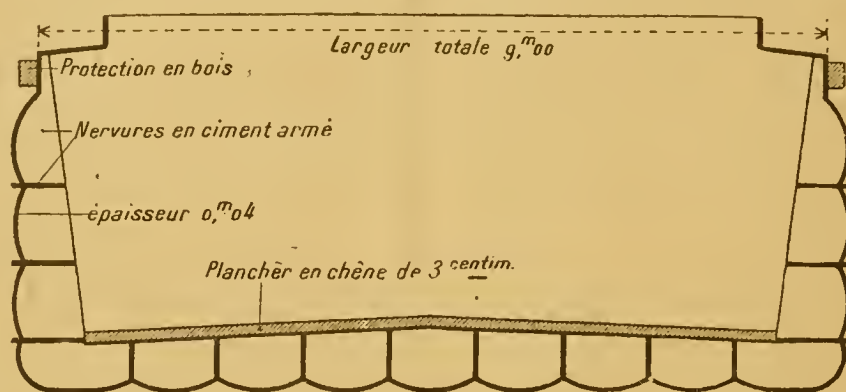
Coupe du chaland Lorton en ciment armé.
